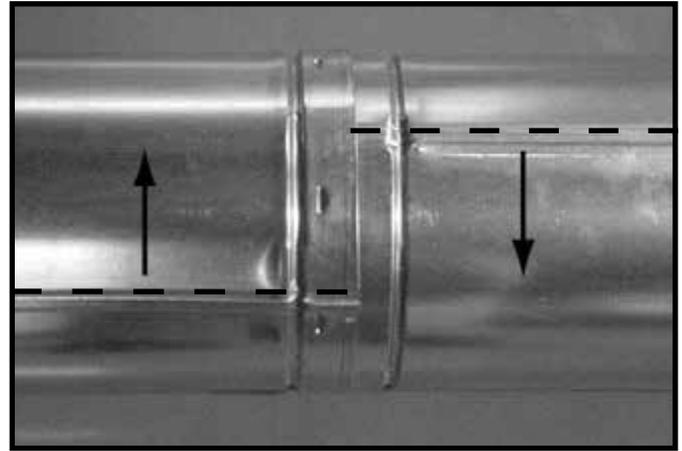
Pivoter les cordons de soudure pour démonter
